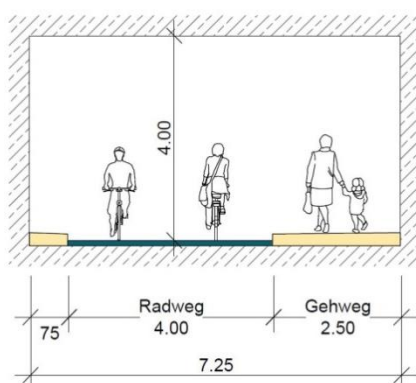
Regelquerschnitt Tunnel mit Gehweg
